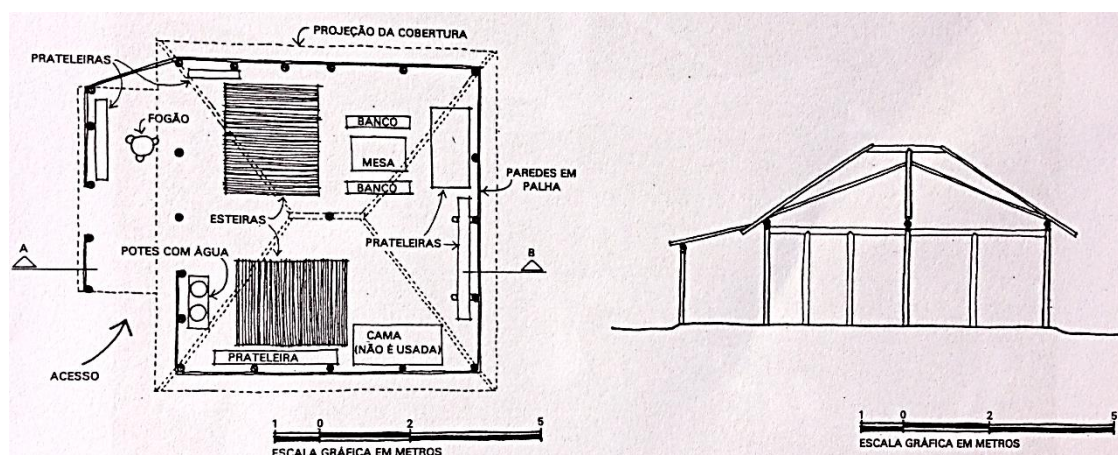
Planta baixa e corte esquemático de casa *karajá*, com cozinha em "puxado".
